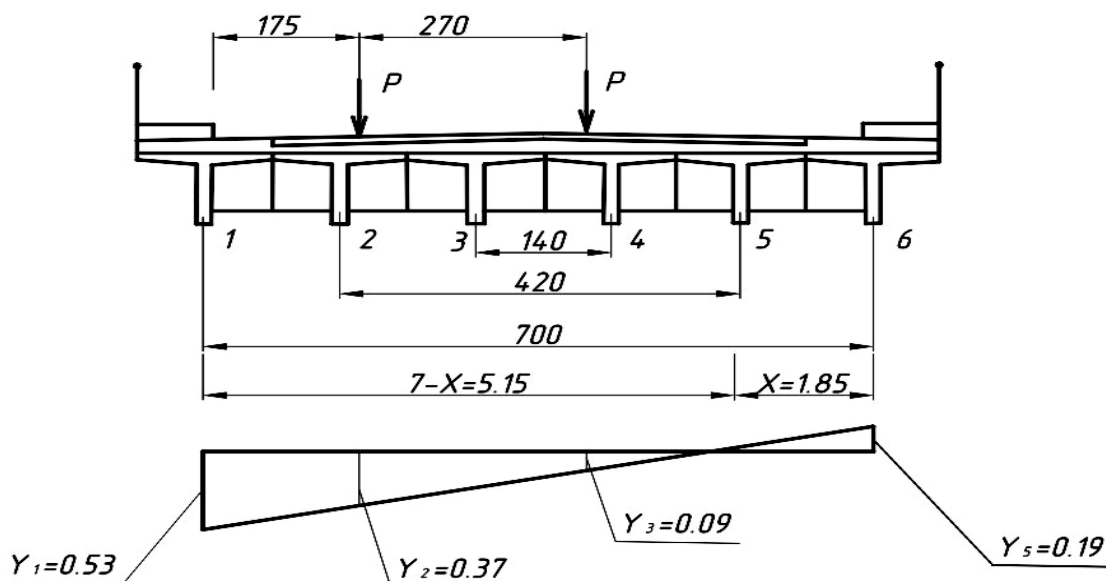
Схема к определению коэффициента поперечной установки при нагрузке НК-80
